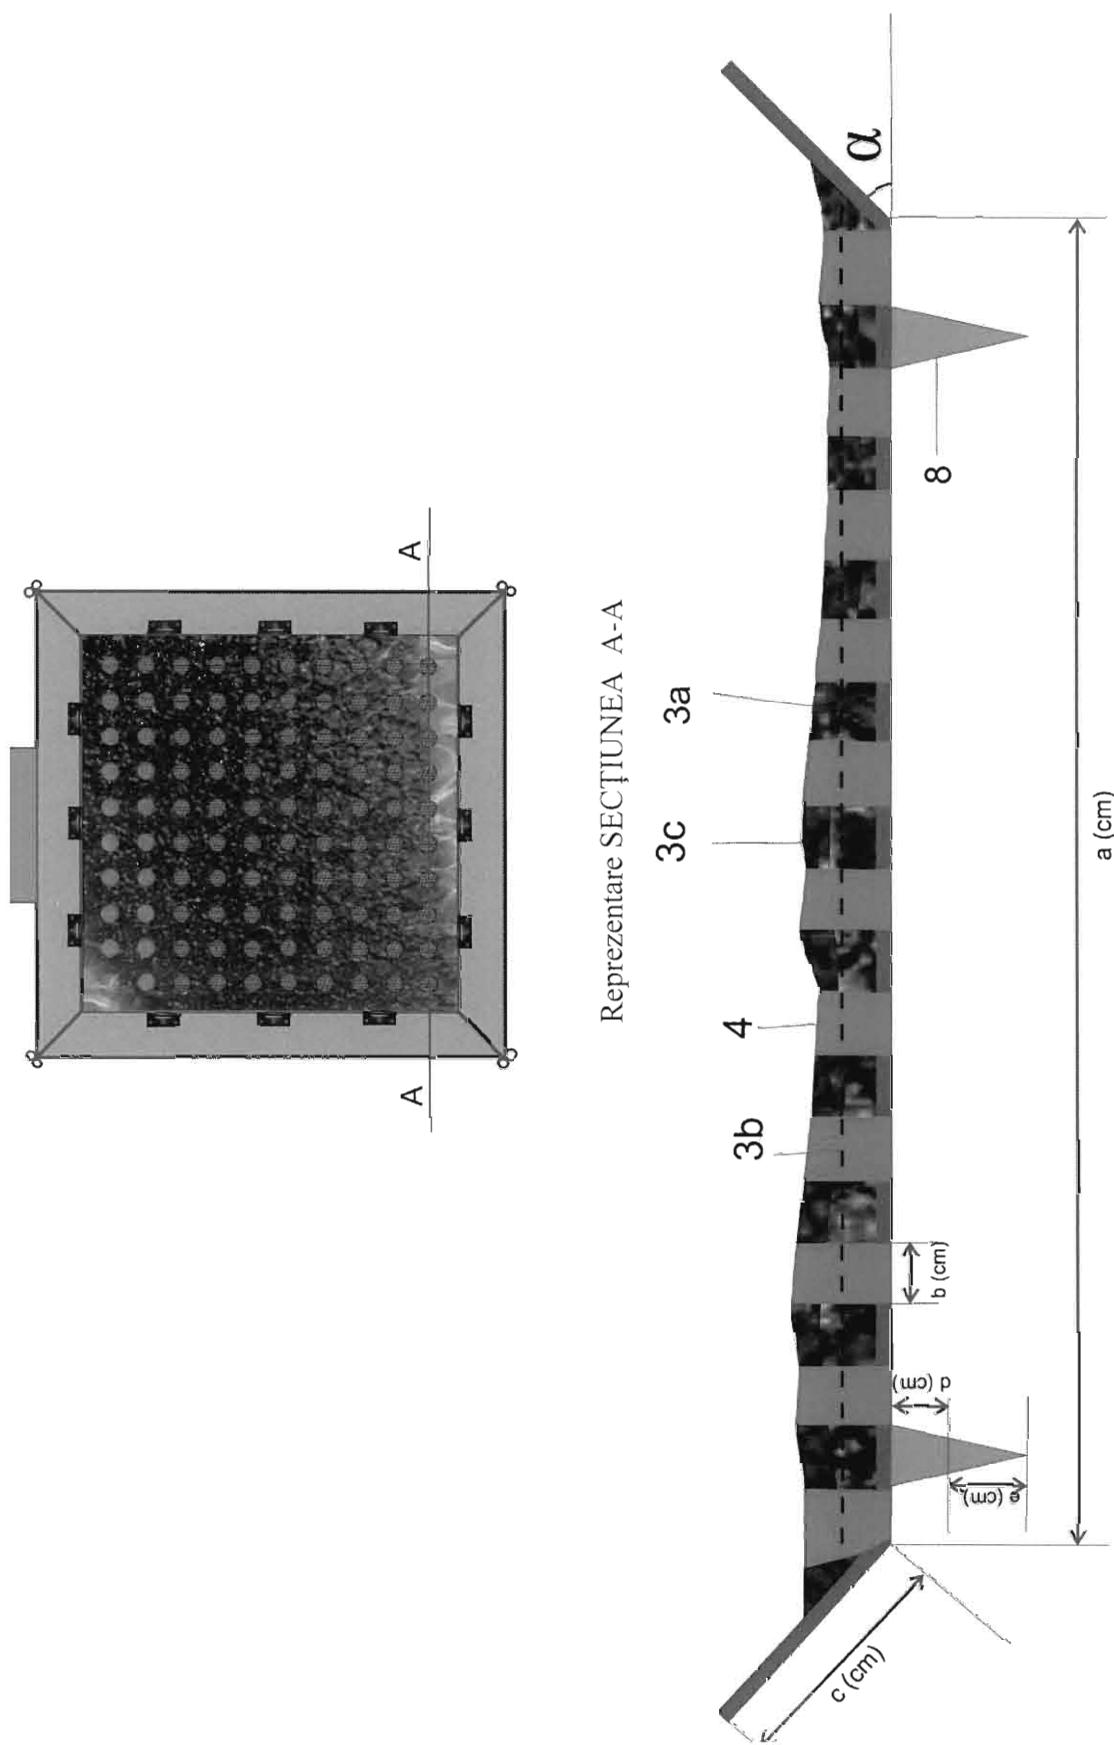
Elemente constructive ale instalației pilot – Secțiune transversală
